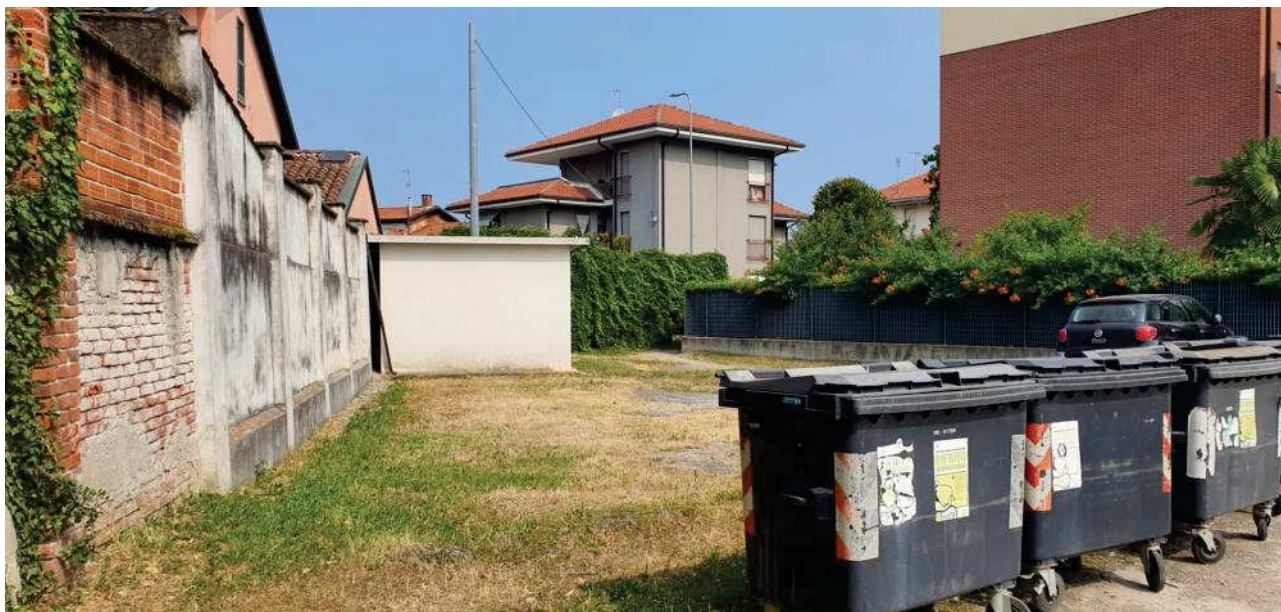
piazzale verso Via Vittorio Veneto (cabina ENEL)
